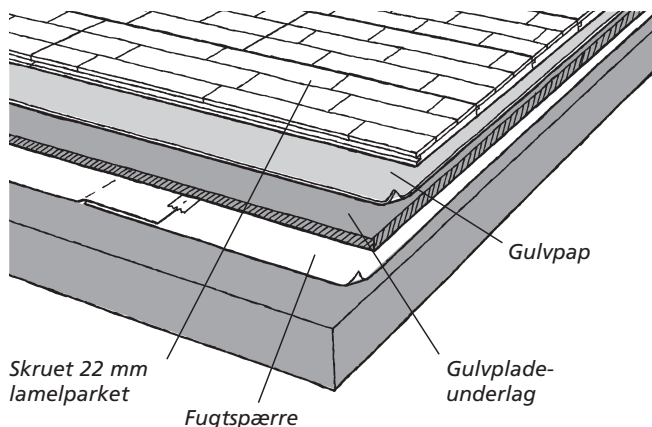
Tegningen viser gulvpladeunderlag, her lagt på et eksisterende betondæk som underlag for 22 mm lamelparket skruet til underlaget.
